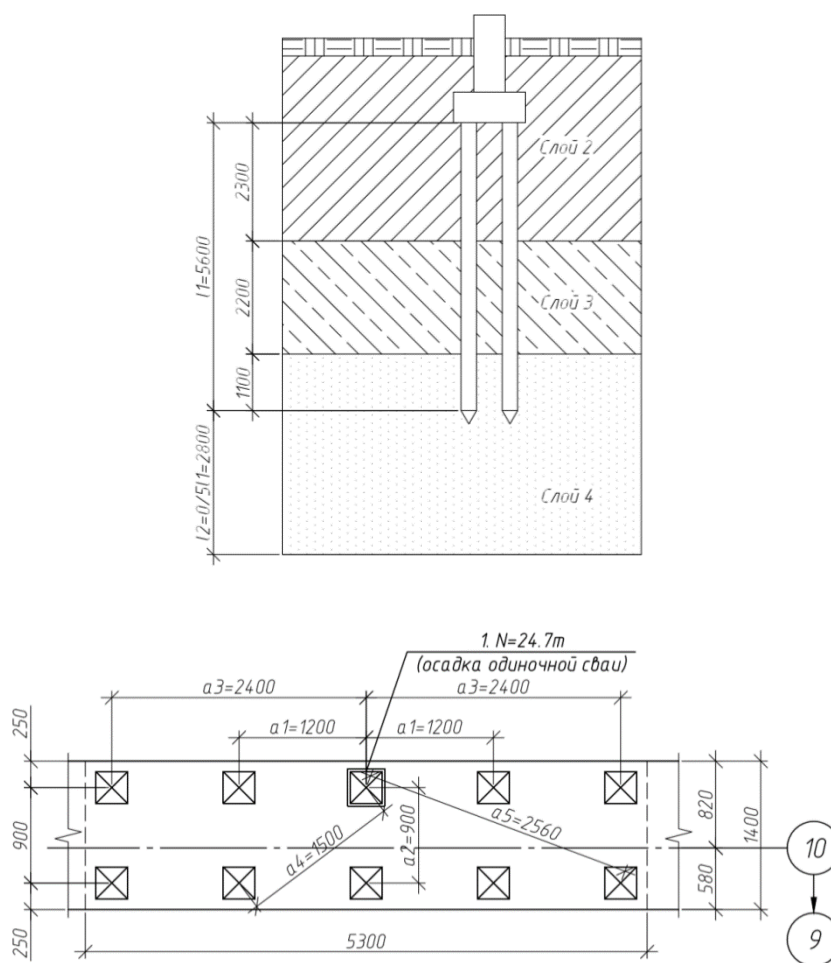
Схемы свайного фундамента для расчета осадки
